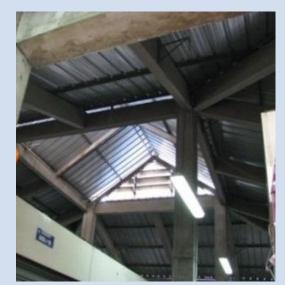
Estructura de cubierta de CCAM Autor: Erika Montenegro. 2013
